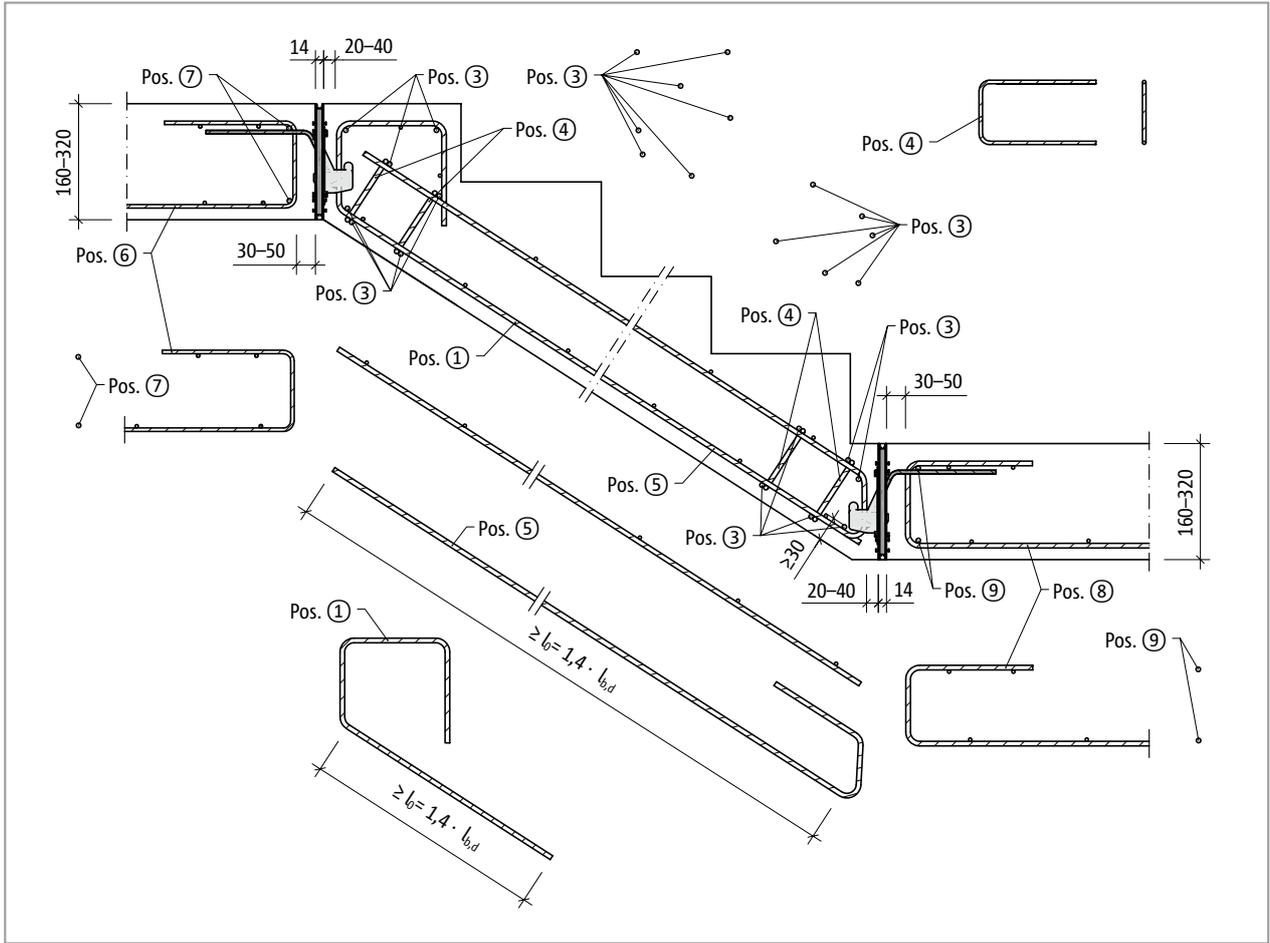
Schöck Tronsole® Typ T: Bauseitige Bewehrung
